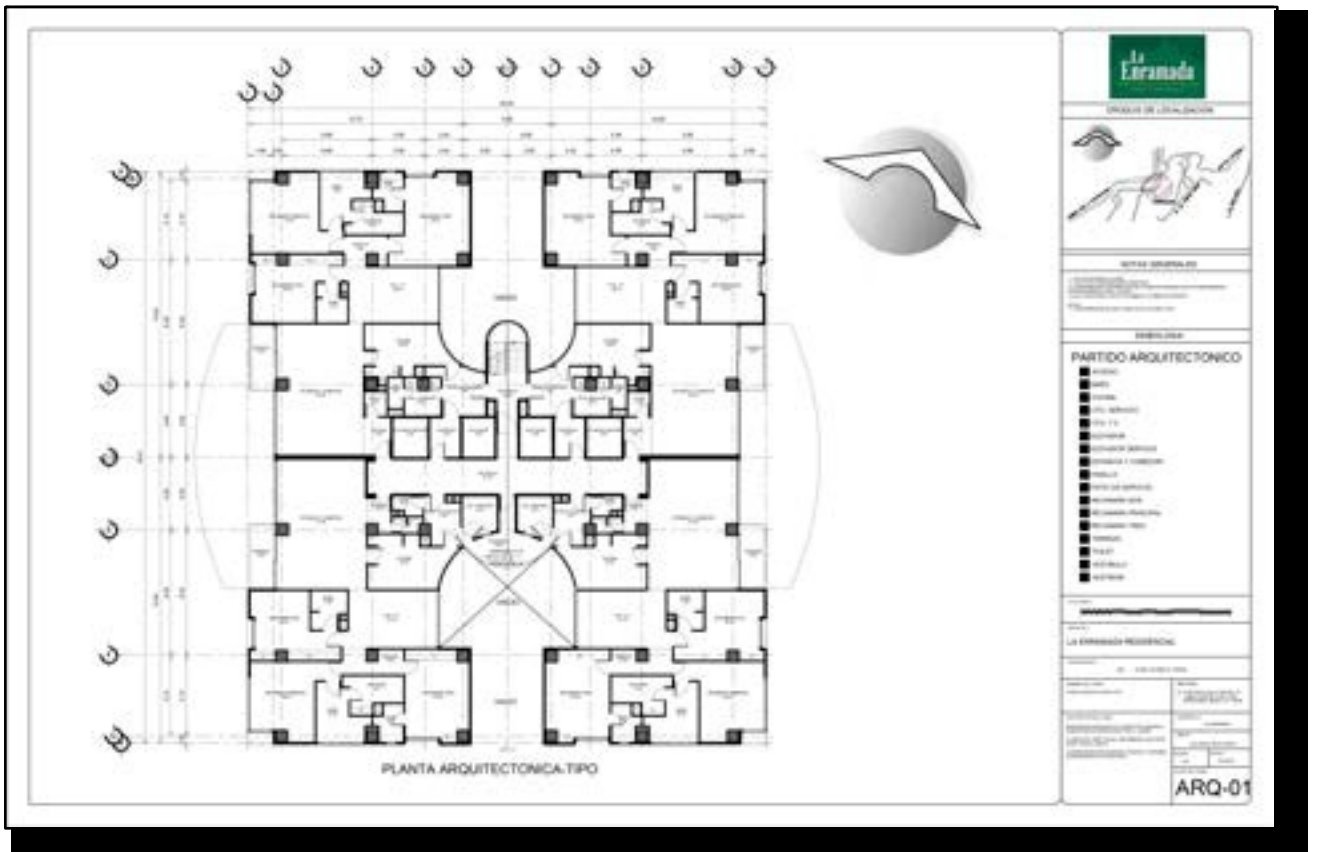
Planta Arquitectónica de “Edificio Tipo”
